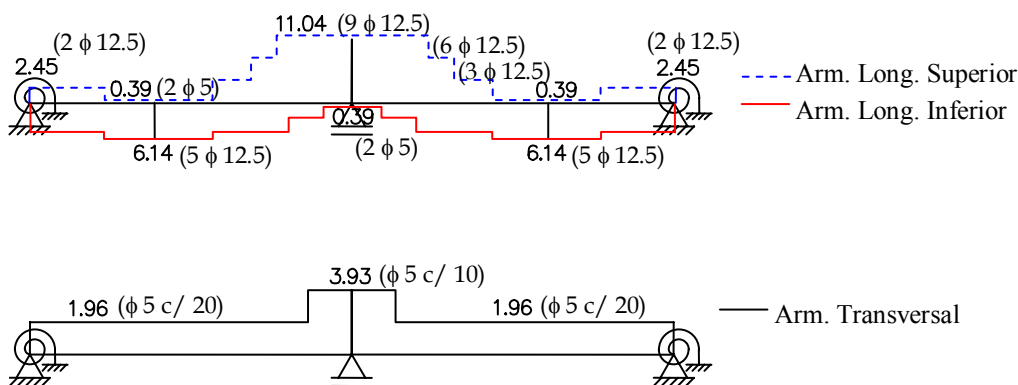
Diagramas de armadura adotada da viga isolada do Exemplo 2 .
